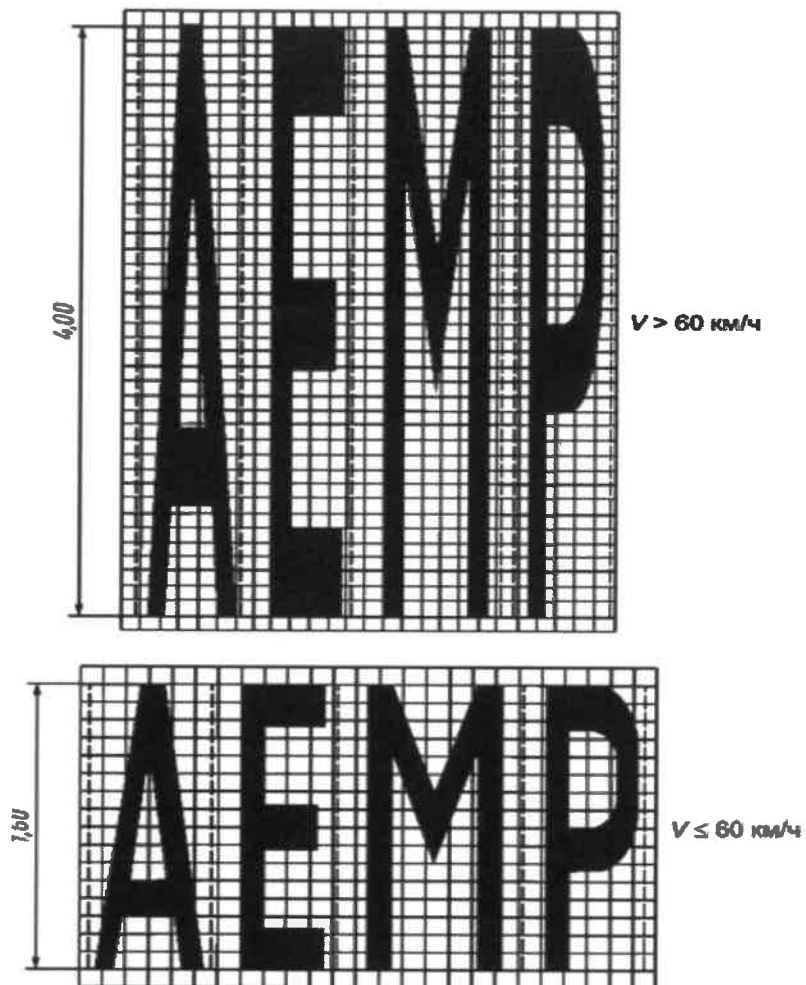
Форма, расположение и размеры букв разметки типа 1.22
